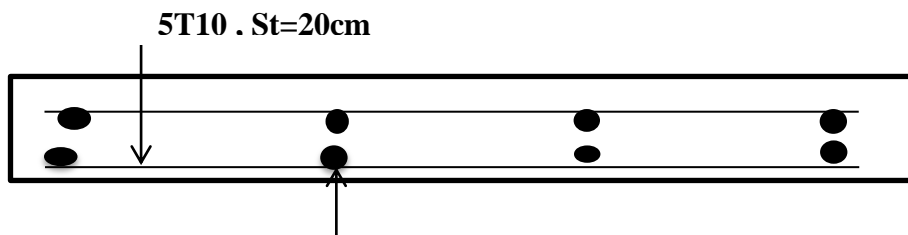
schéma de ferrailage de la dalle pleine type3.
